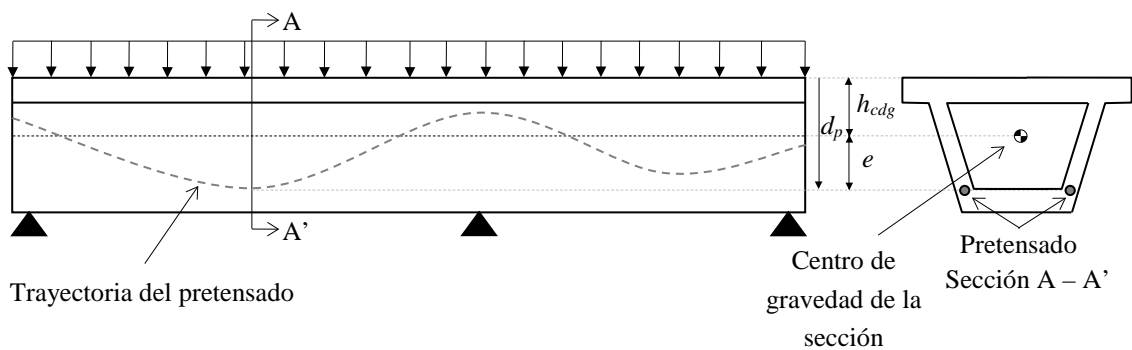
Esquema general del problema de diseño de una viga continua de hormigón pretensado
